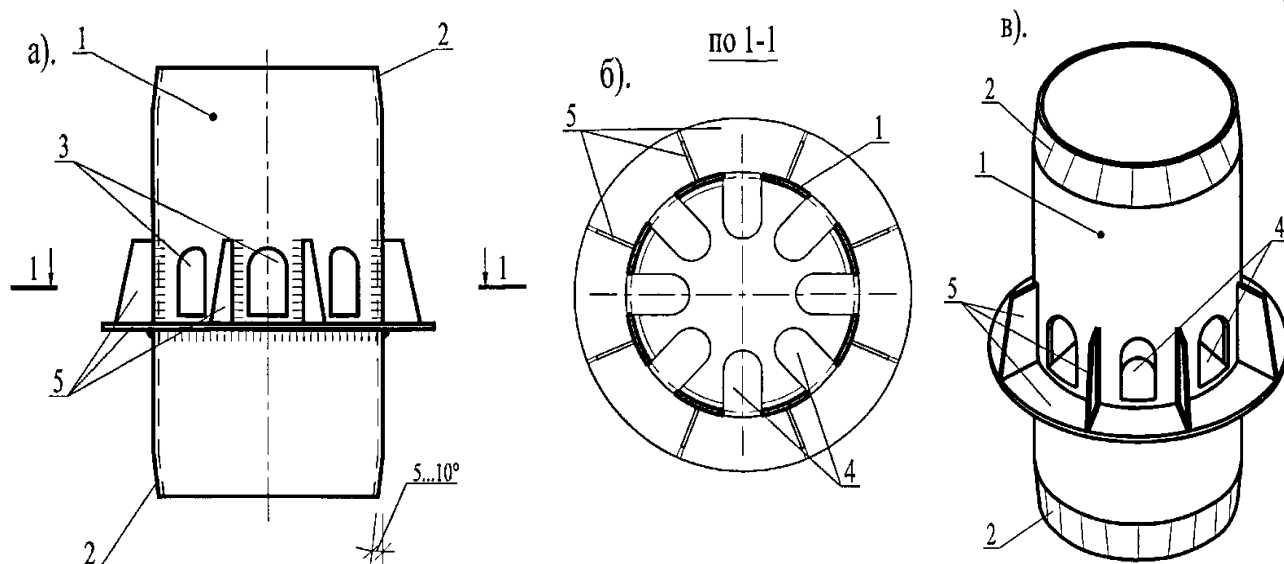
Конструкція з'єднувальної гільзи для безбалкового перекриття
